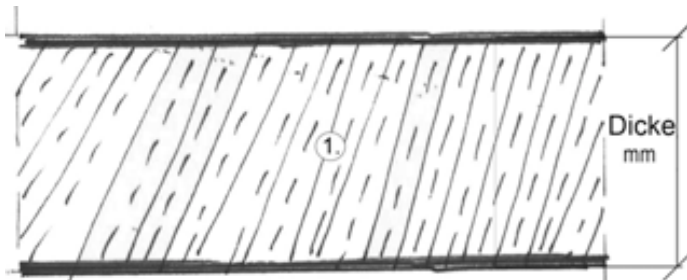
Horizontale Elemente , Gründung Fußböden Typ 1 Bestand
